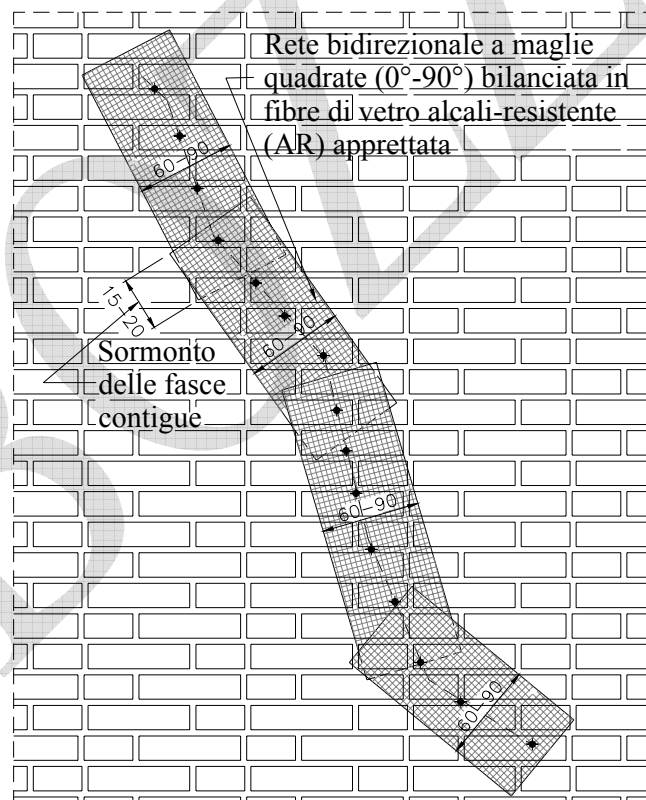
Applicazione di rete di rinforzo: vista prospettica
